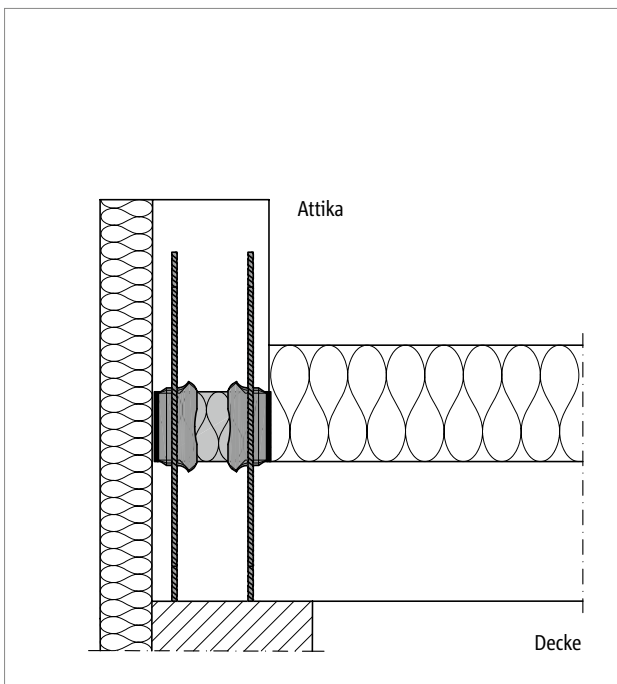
Schöck Isokorb® CXT Typ A: Anschluss einer Attika
